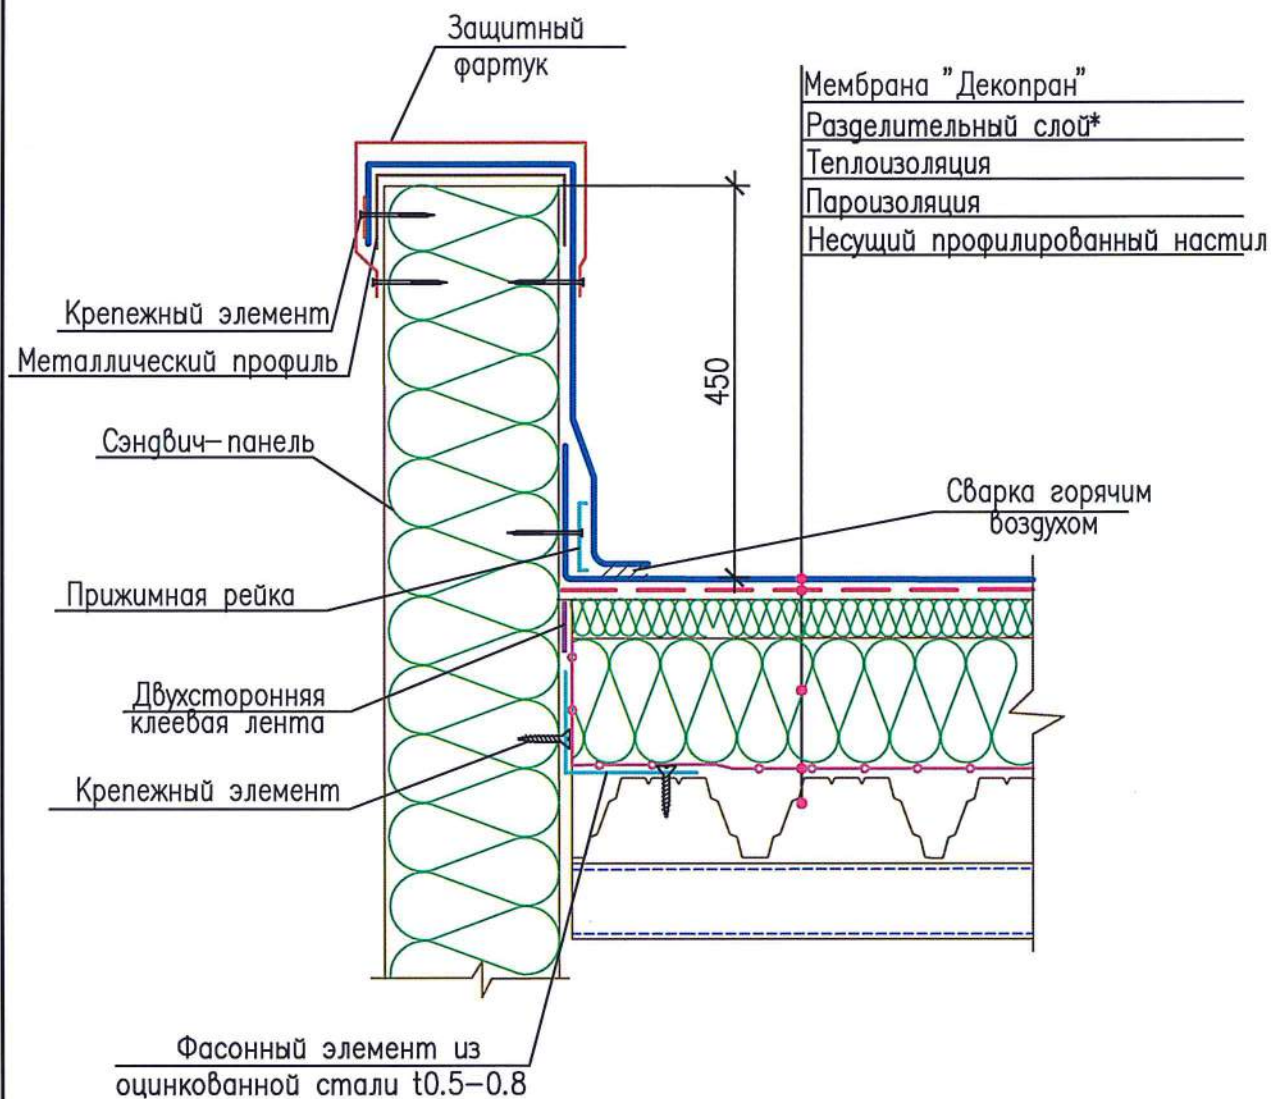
Конструктивное решение узла для кровли с несущим профилированным настилом с механическим креплением.
